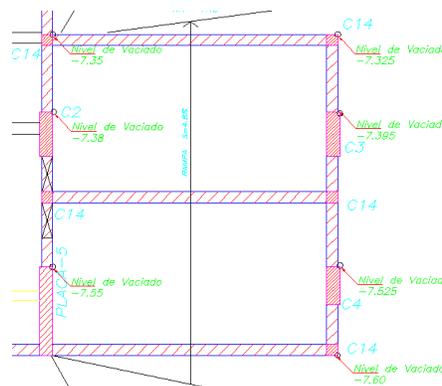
Ubicación de Elementos Estructurales - Placas, Columnas, Muros de Contención.
